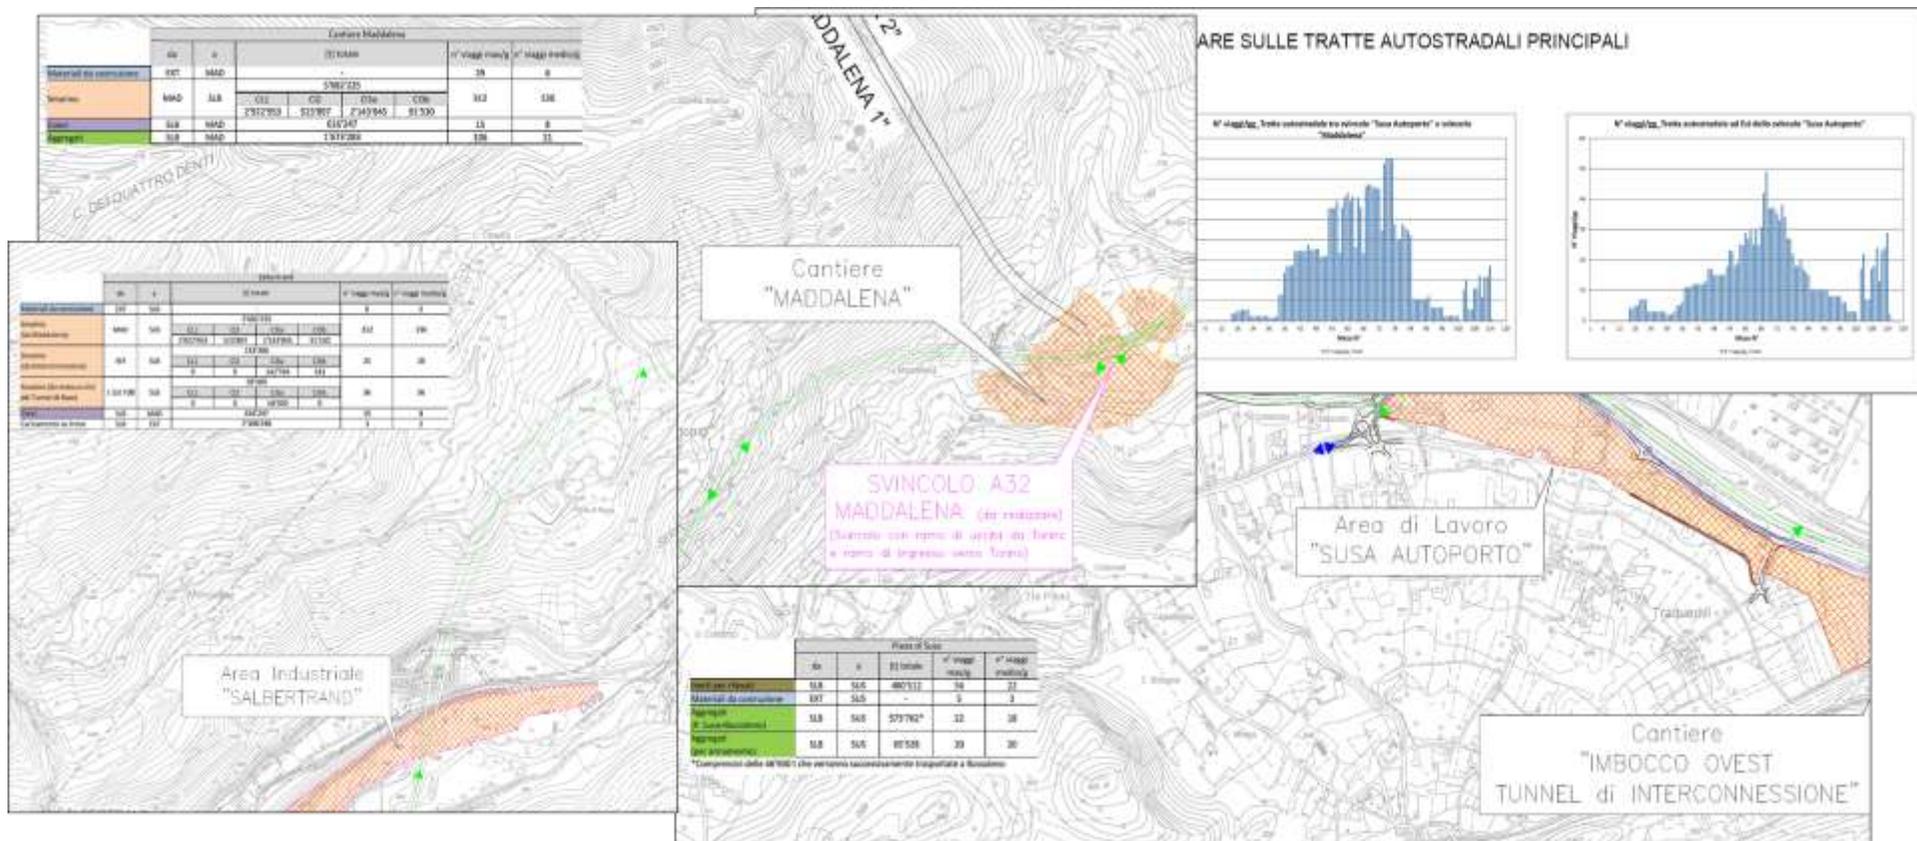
Stralci estratti dall'elaborato PRVC3ATSE-37754\_Planimetria con flussi dei materiali
